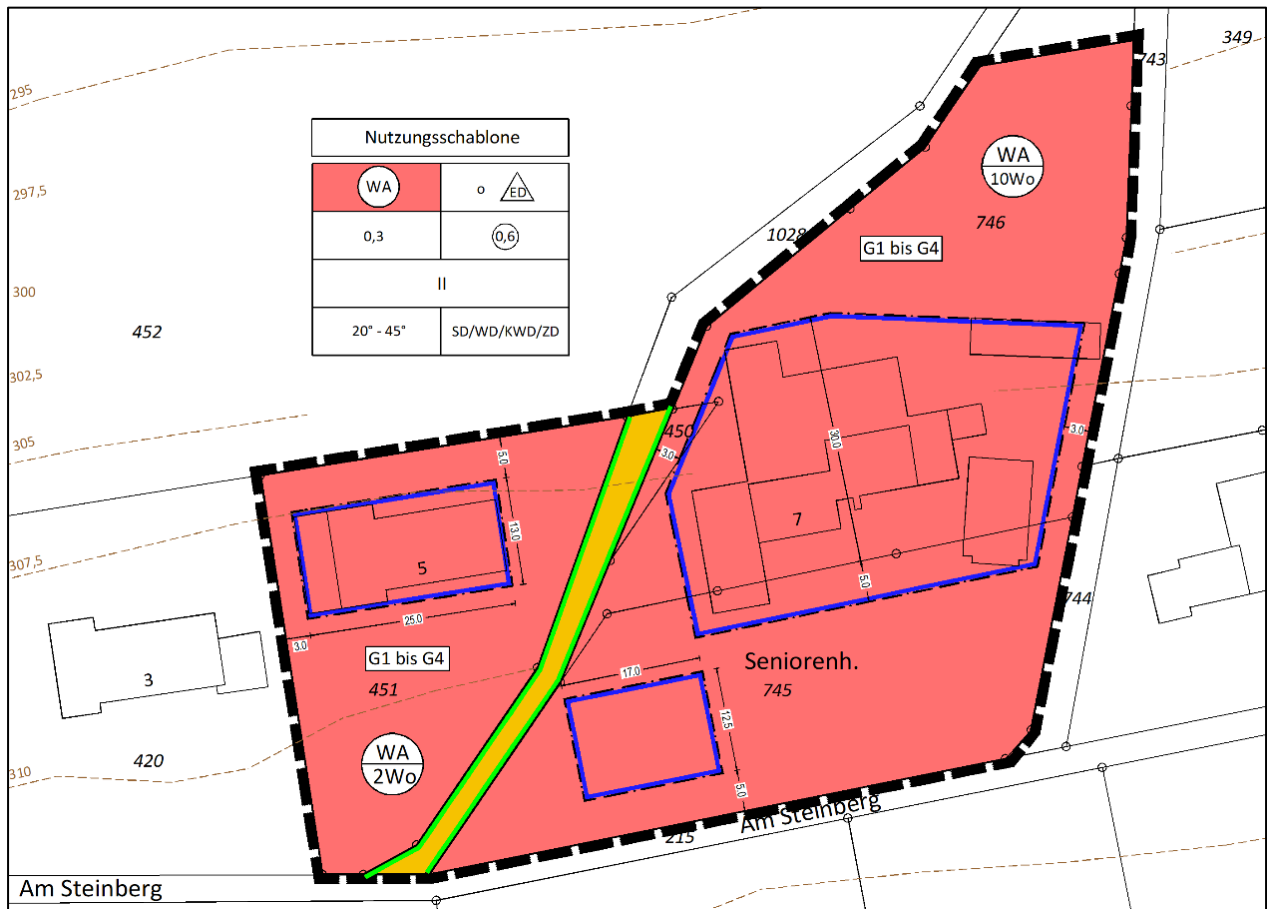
Planzeichnung Bebauungsplan, Quelle: HKS, 2023
